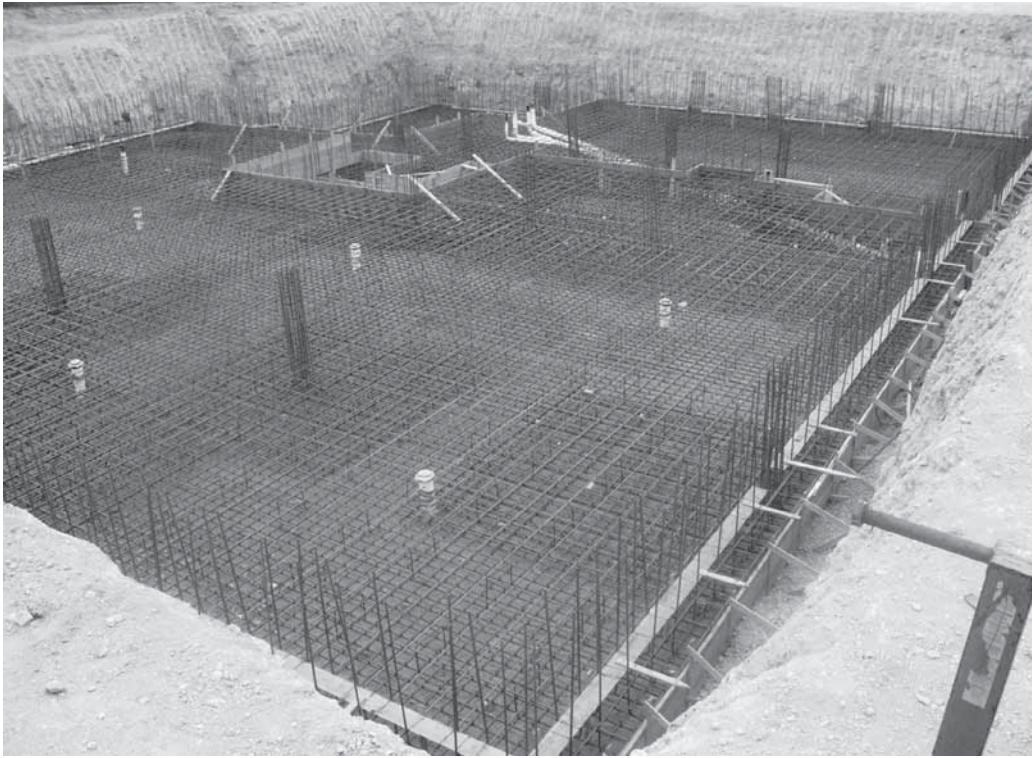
Losa de cimentación de placa plana en proceso de construcción. (Cortesía de Dharma Shakya, Geotechnical Solutions, Inc., Irvine, California).
